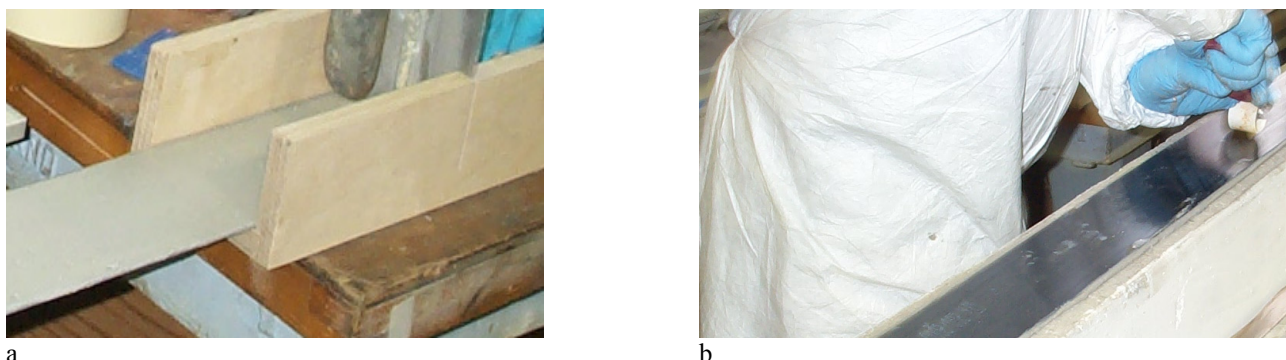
Placarea grinzii din beton armat: (a) - aplicarea stratului de adeziv pe fâșia compozită; (b) - presarea fâșiei din CPAFC pe suprafața de beton a grinzii / The plate bonding on the reinforced concrete beam: (a) - application of the adhesive layer on the composite strip; (b) - pressing the CFRP strip on the beam concrete surface.
